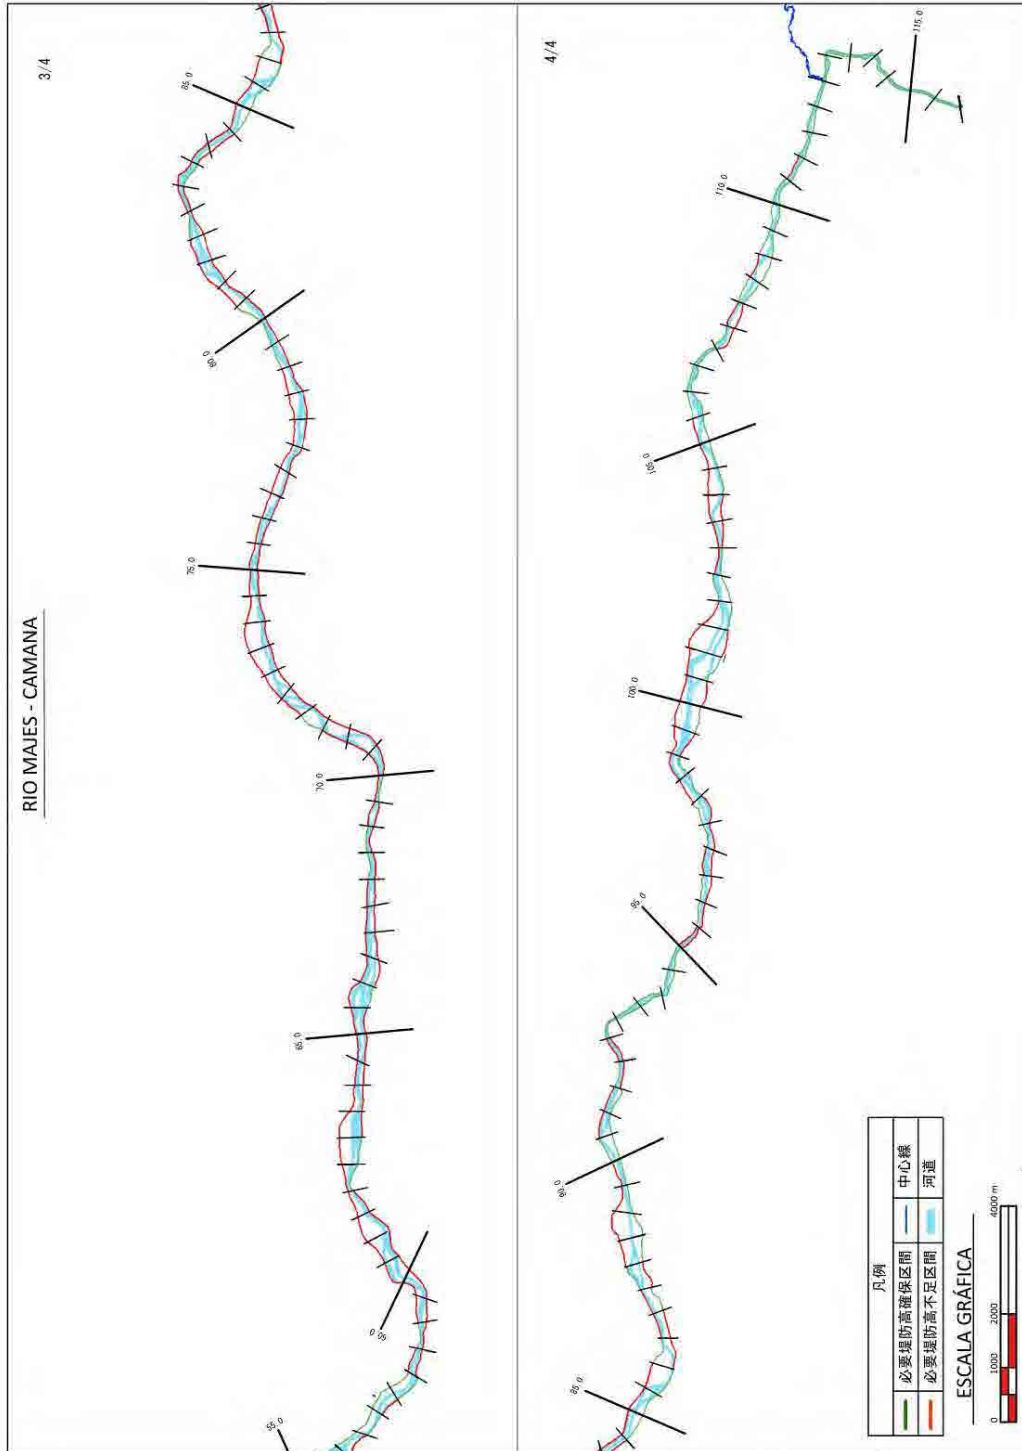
マヘスーカマナ川平面図 (55-115K)
